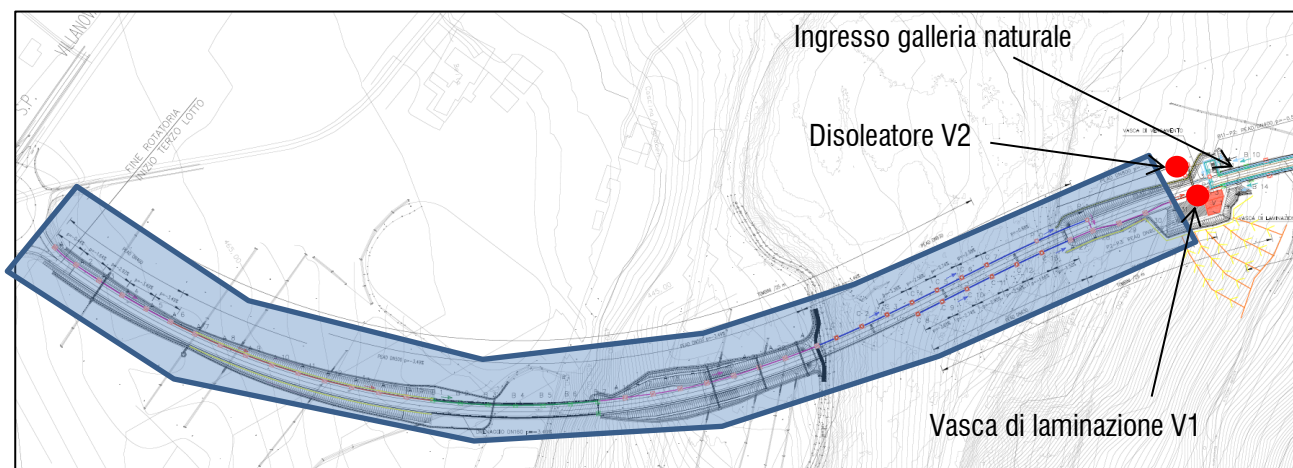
Area di progetto interessata alla laminazione della vasca V1.
